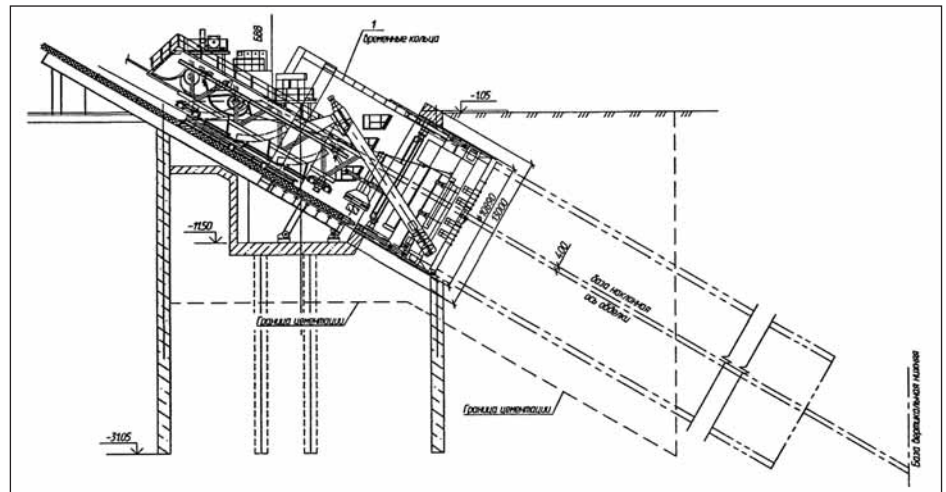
Схема начала проходки наклонного хода щитовым комплексом из стартового котлована
